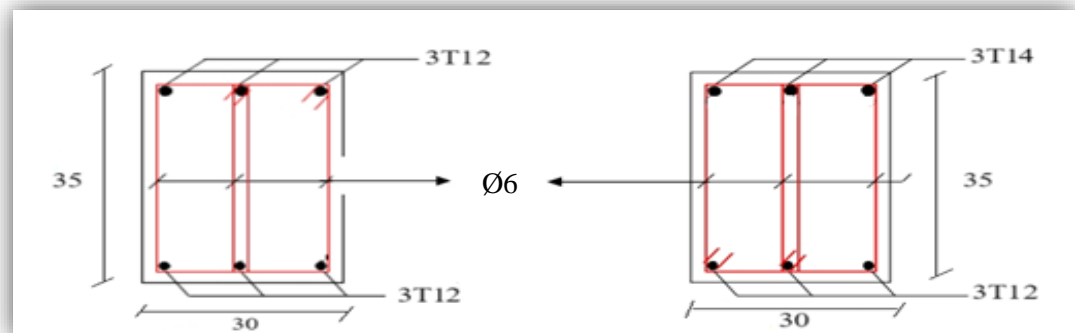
Schéma de ferrailage des poutres secondaire intermédiaire (Etage et Terrasse).
